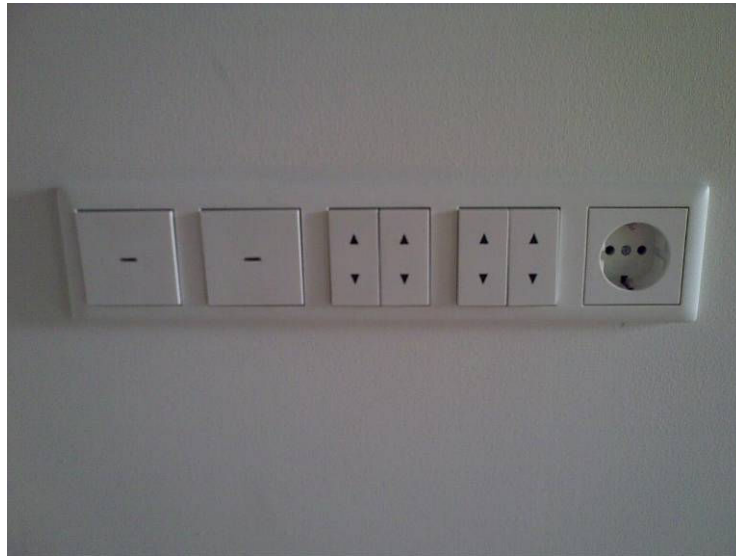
Bedieningspaneel voor onder andere verlichting in woonkamer
